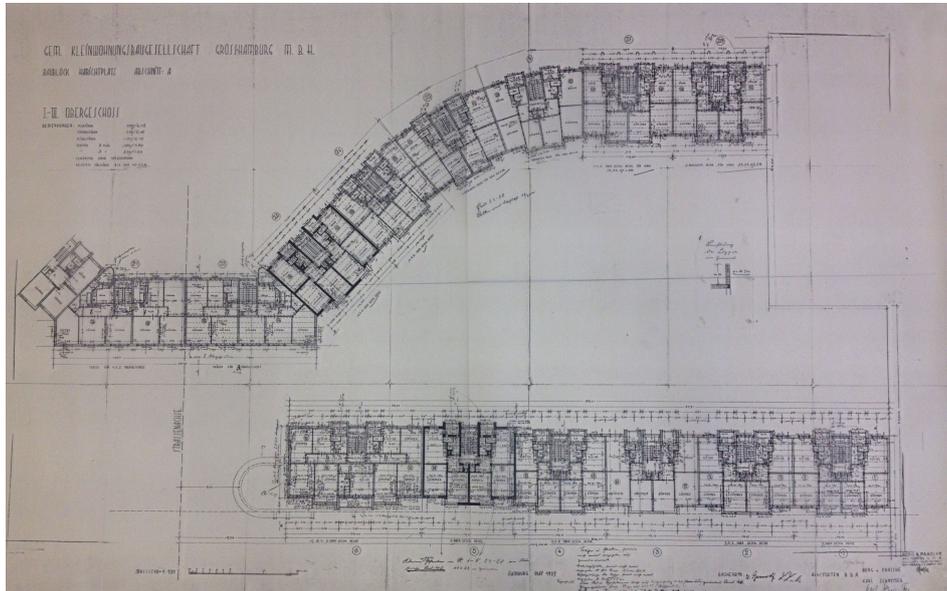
Grundriss Abschnitt A, 1.-3. Obergeschoss, Mai 1927
